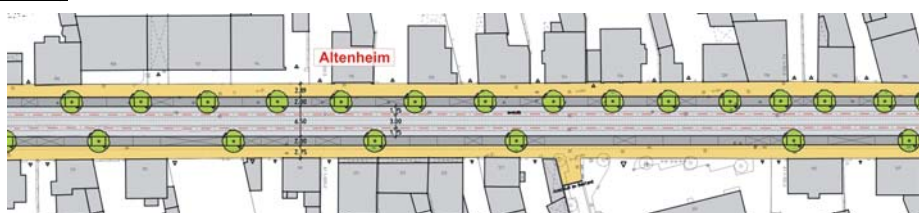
Lageplan „Fehlende/zu wenig Querungsstellen Fußgänger“
